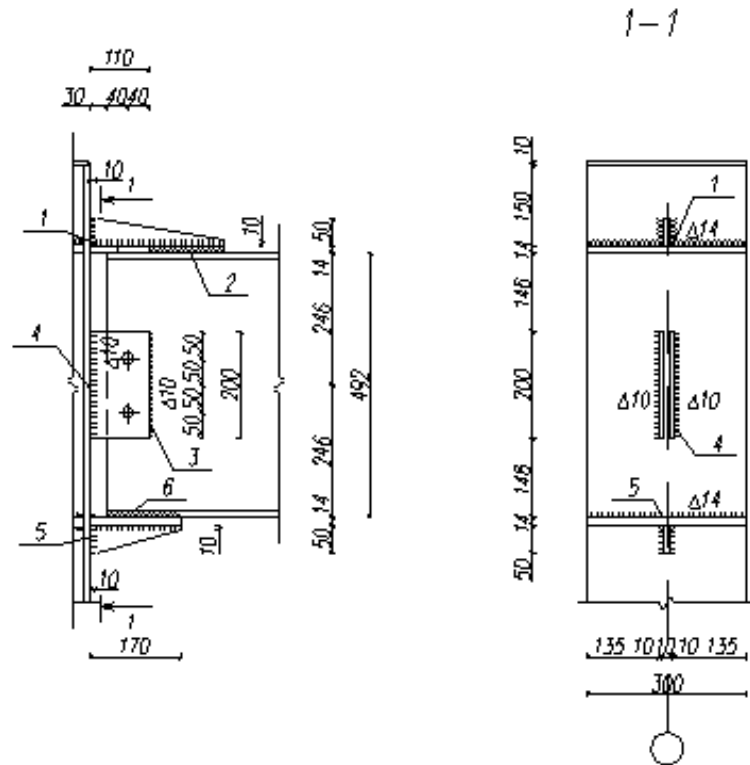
Схема кріплення ригеля до колони, вузол 2.
